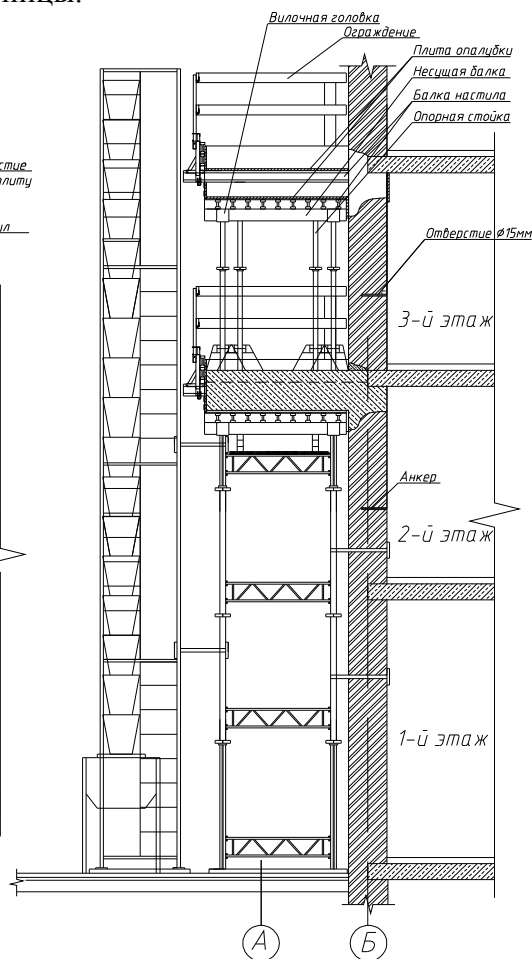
Установка опалубки под балку и плиту балкона 4-го этажа
